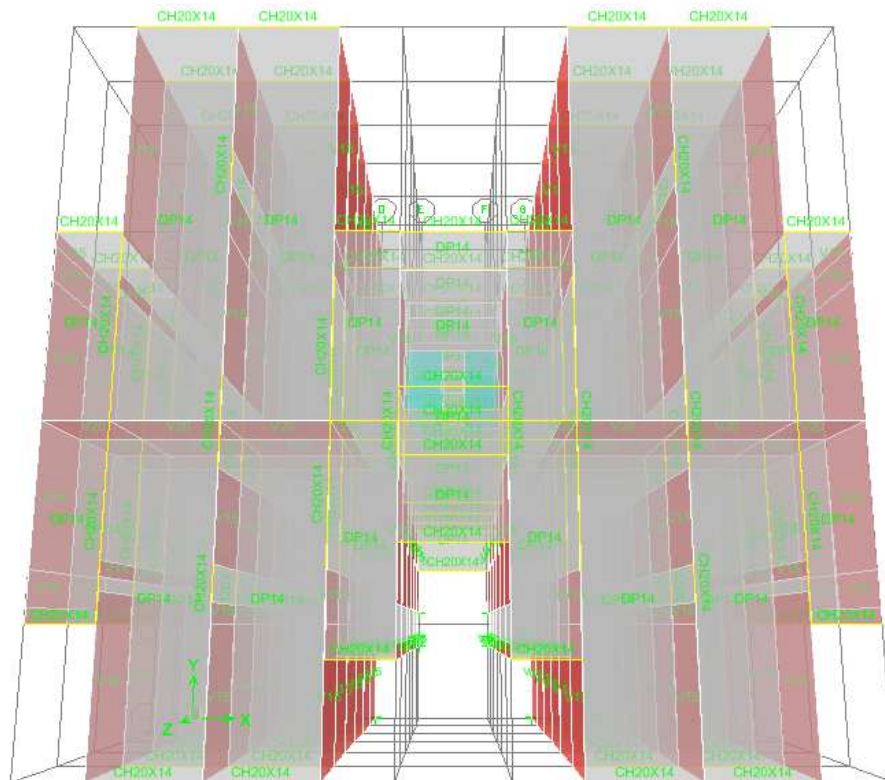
image 3D de la structure (coffrage tunnel) sur ETABS
